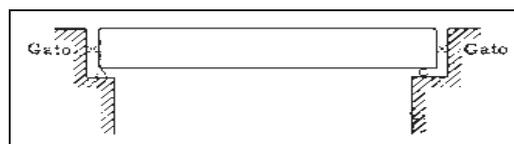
Presforzado de una viga de concreto simple al colocar gatos contra los estribos [2].
